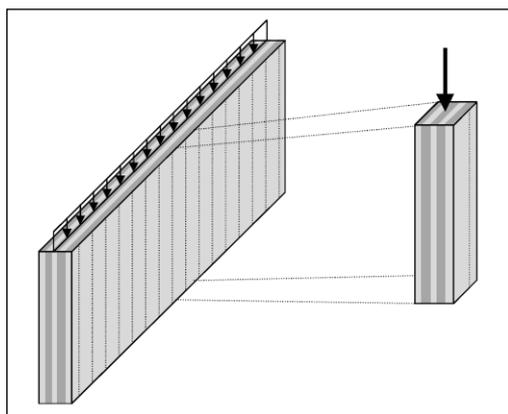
Elemento di parete soggetto a carichi verticali.
